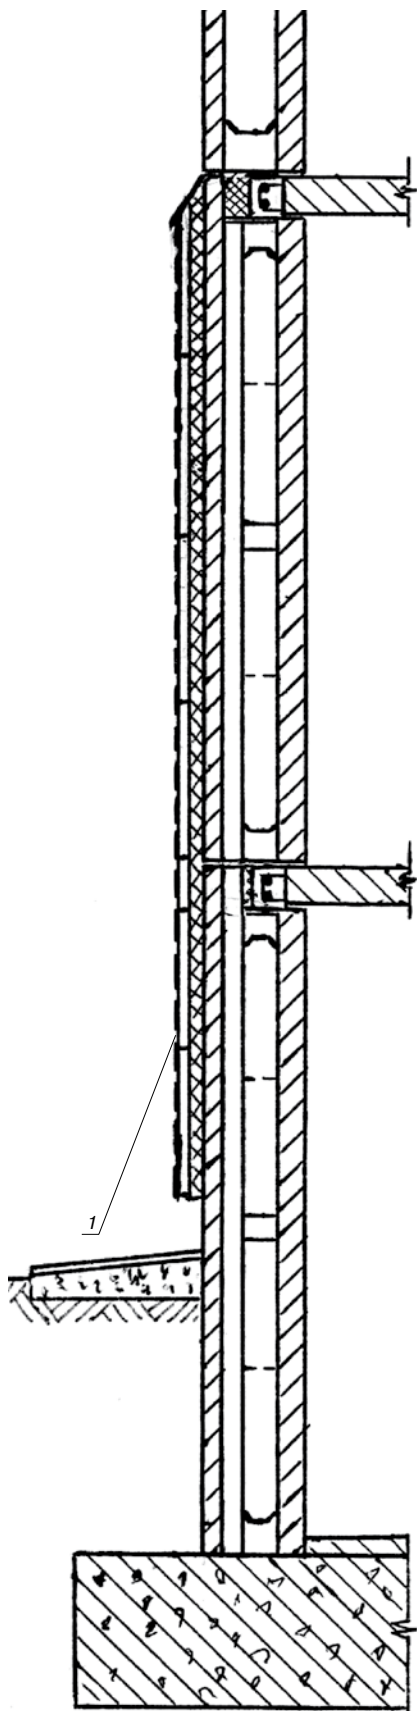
Сечение наружной стены по цокольной панели и панелям 1-го и 2-го этажей с навесным фасадом по верхней части цокольной панели и панели 1-го этажа: 1 – навесной фасад
